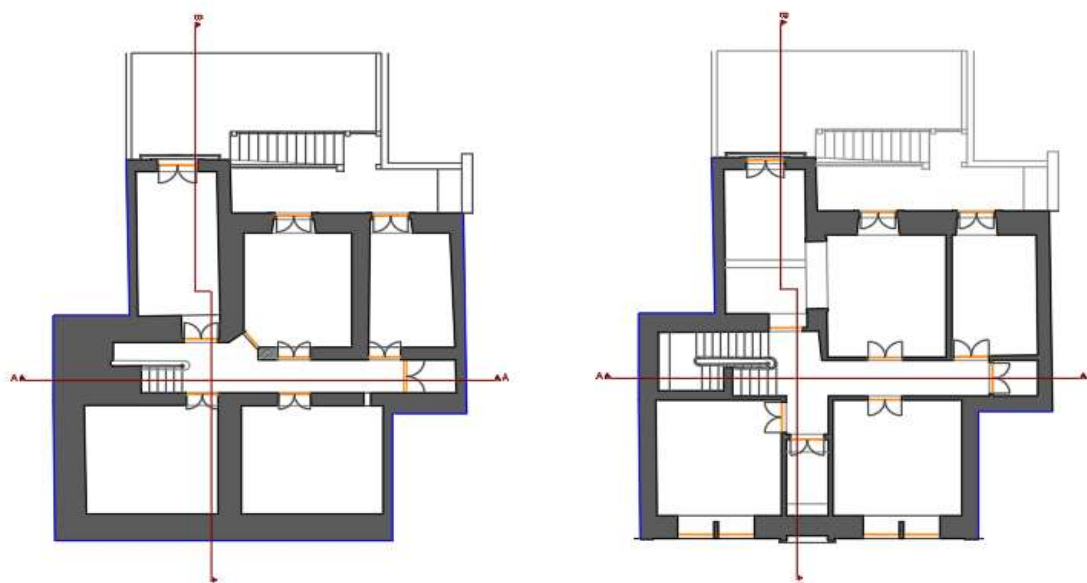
Planta do edifício do piso da subcave (esq.); Planta do edifício da cave (dir.)
